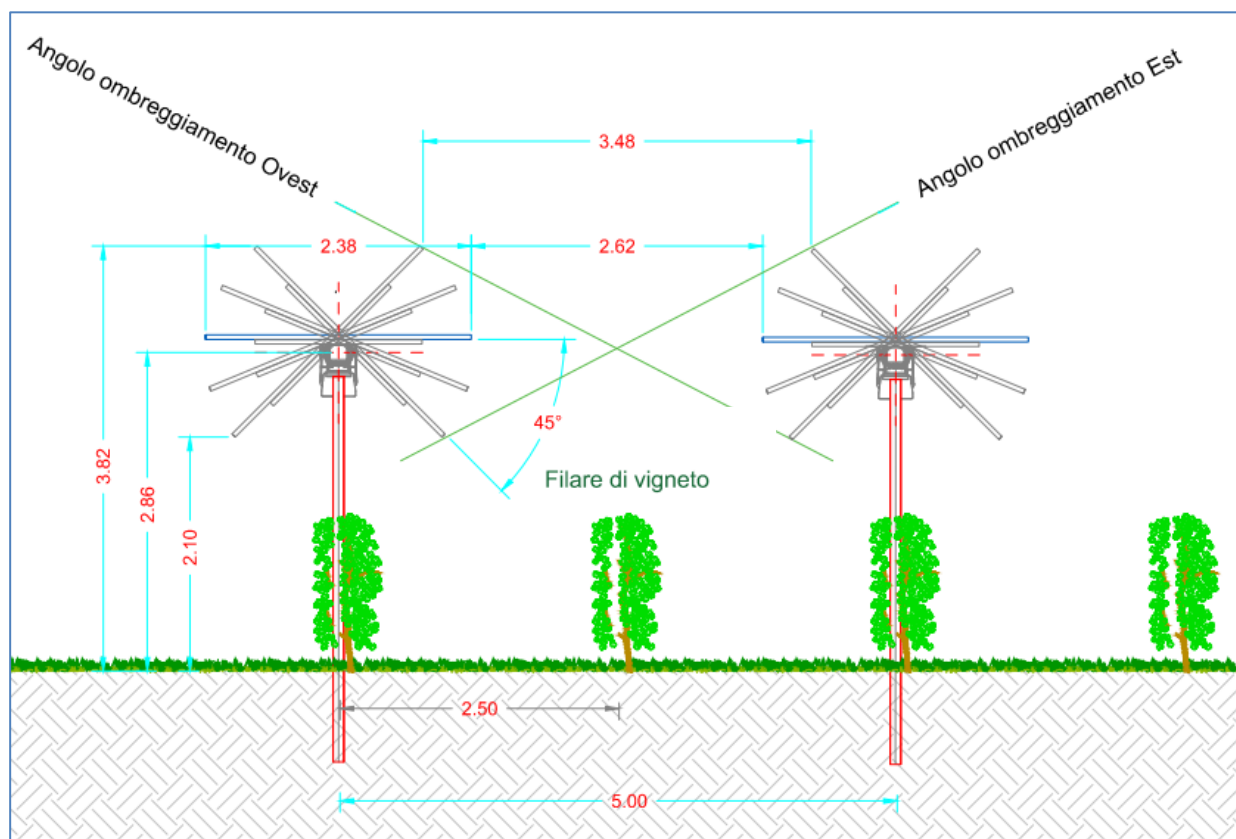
B. Sezione longitudinale tipologica struttura Tracker
